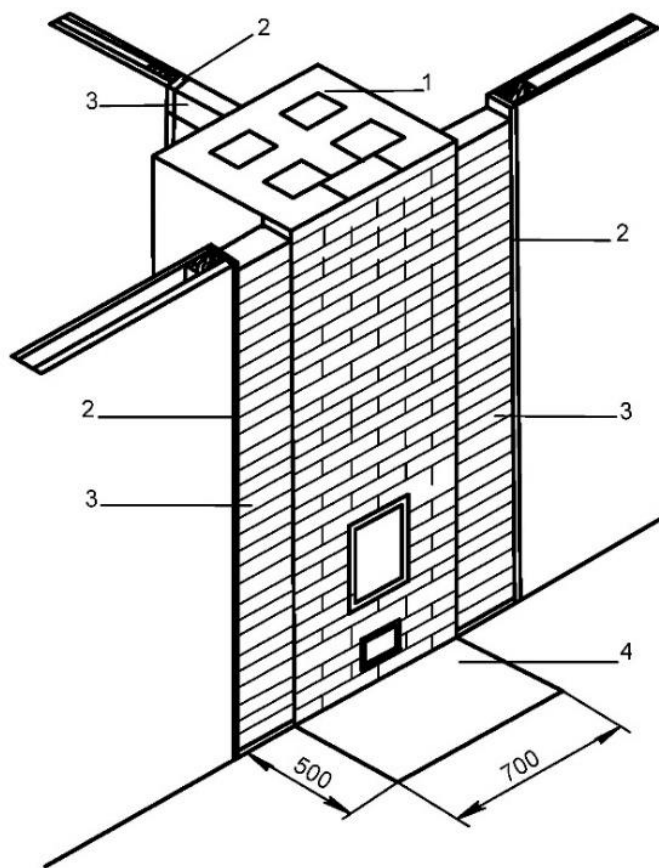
Вертикальные противопожарные разделки: 1 – отопительная печь, 2 – войлок или асбест, 3 –кирпичная кладка, 4 – металлический лист.
